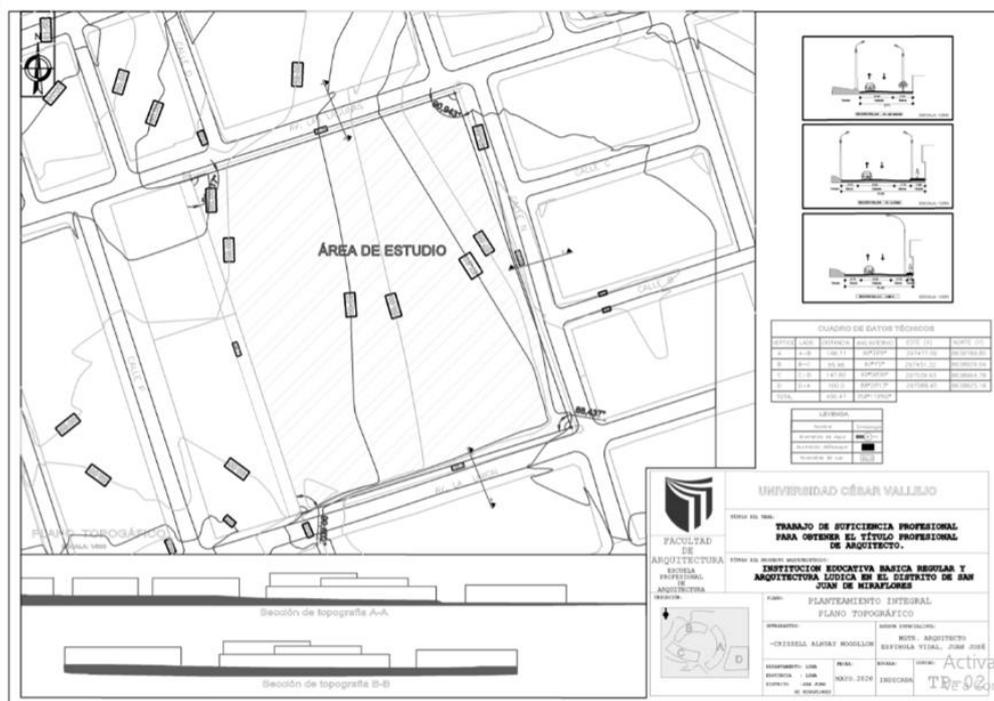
Plano de levantamiento topográfico de la edificación. Fuente: Elaboración propia.
